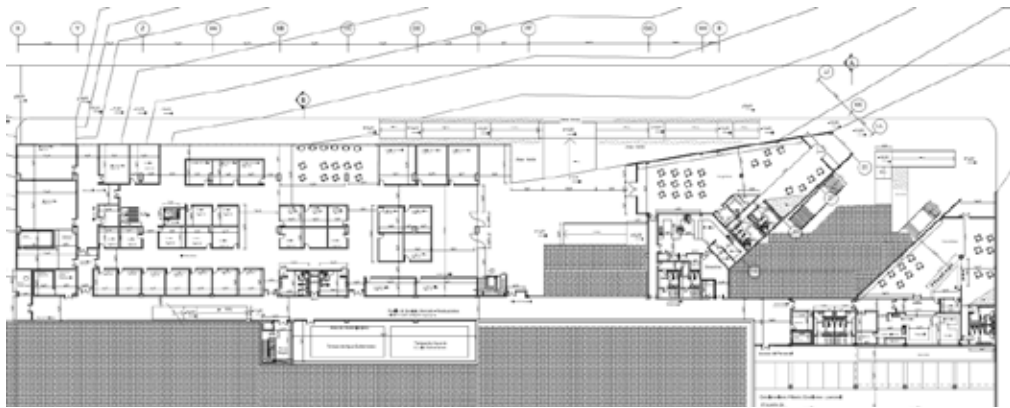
Vista Planta Nivel -11.00 - Malavé (2017)
